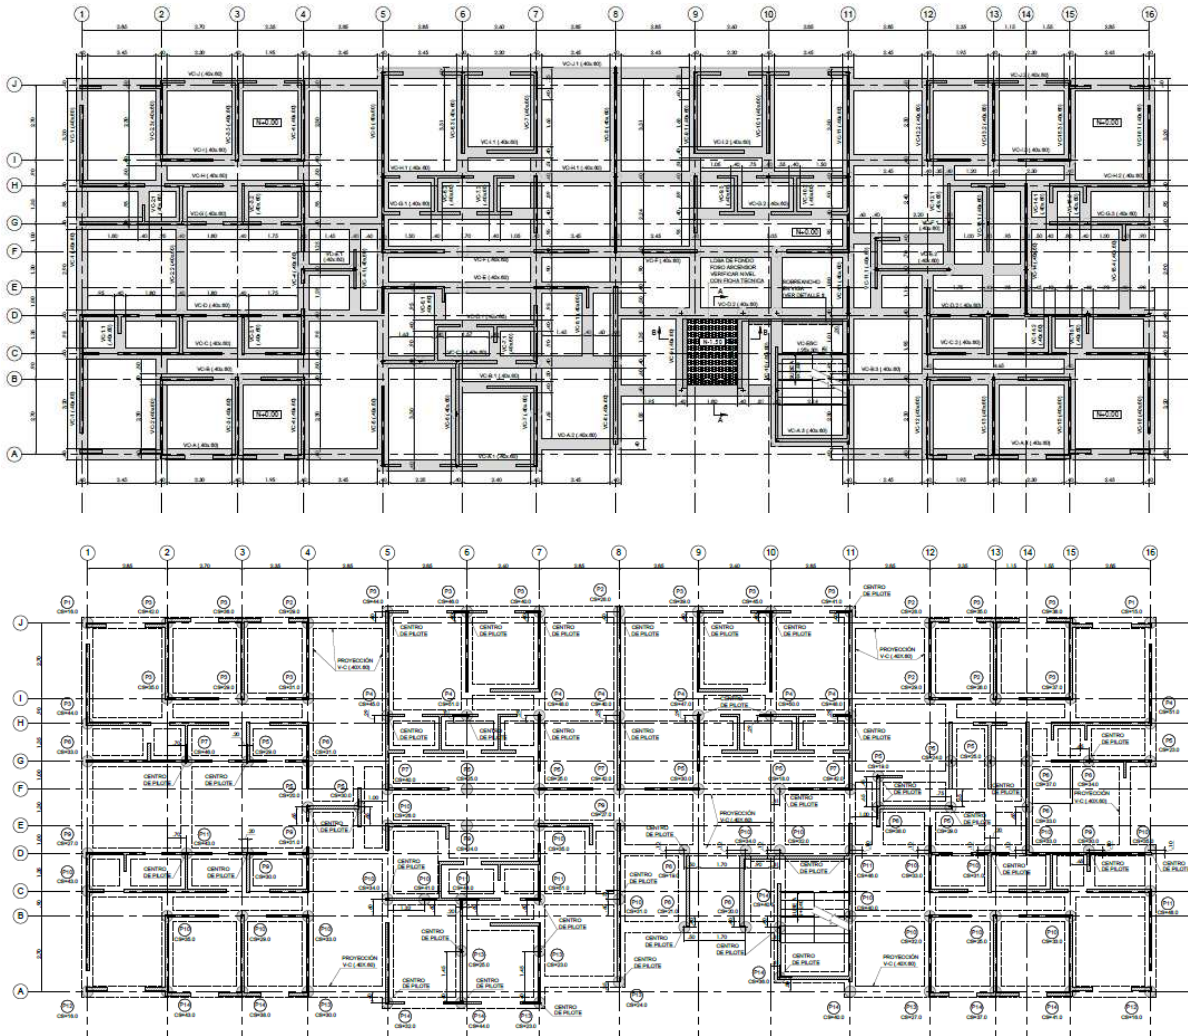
Planta típica de cimentación con viga corrida sobre pilotes. Fuente: Imágenes de planos DUAL INGENIERÍA ESTRUCTURAL SAS. Archivo personal, recuperado en el 2017.
